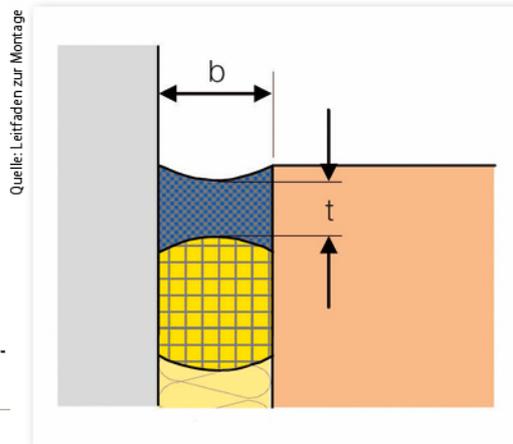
Grundsätze für den fachgerechten Einbau von Dichtstoffen in Bauteilanschlussfugen
